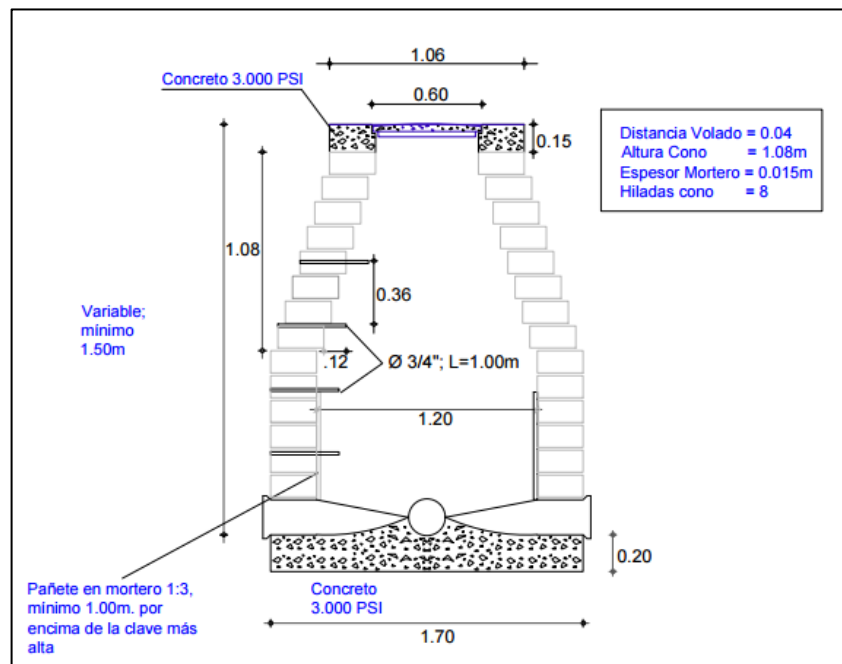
Detalle de pozo de inspección de altura mayor a 2.5 m. (Fuente: Diseños alcantarillado EROCOM)
